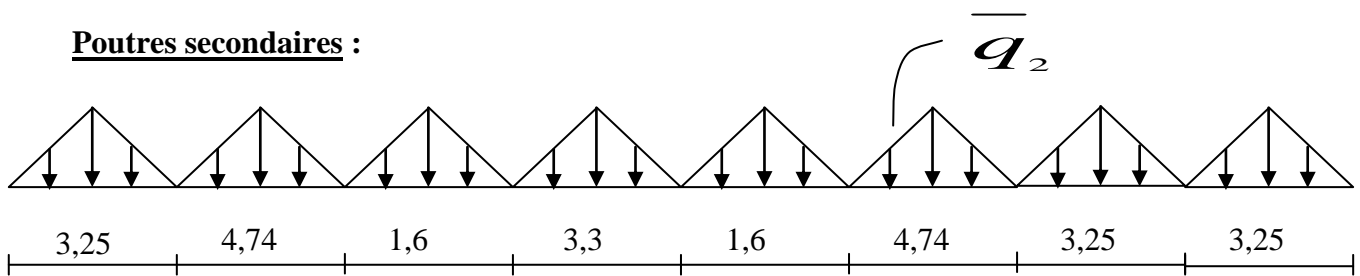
Répartition des charges sur les poutres secondaires
